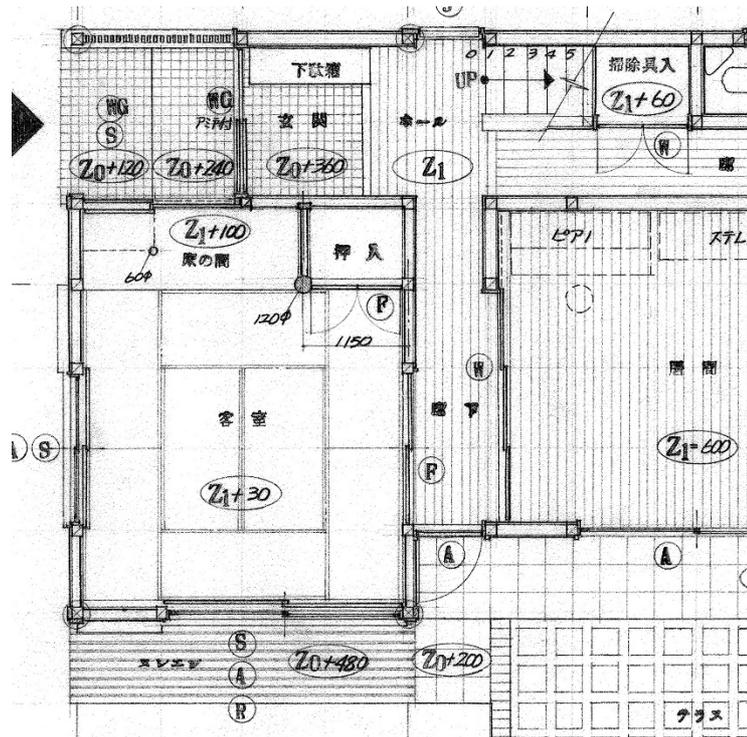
「沢柳邸」(1973) 1階平面図(部分)
